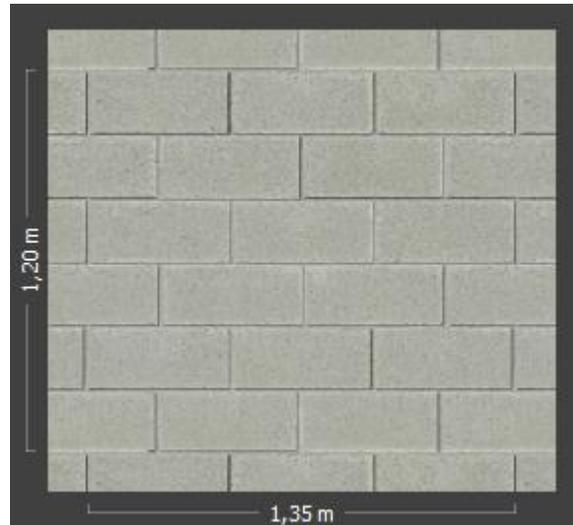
Imagen para el renderizado de los muros de bloques modulares
